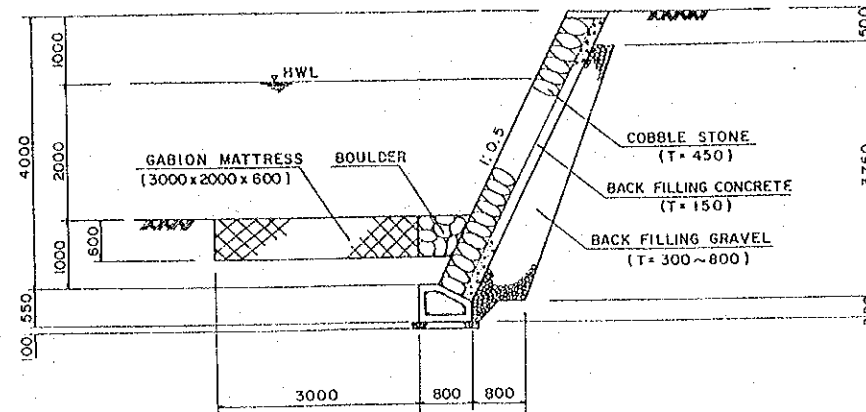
(1/2) ESTRUCTURA GENERAL DE ESTRUCTURAS RIBEREÑAS (PLAN PROPUESTO) (RIO ACHIGUATE)
